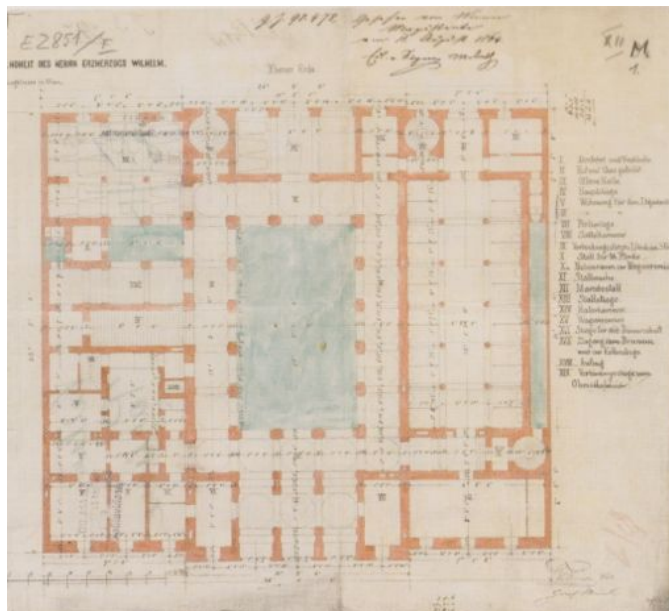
Theophil Hansen, Palais Erzherzog Wilhelm, Einreichplan vom 11. August 1864, Grundriss Erdgeschoss.
